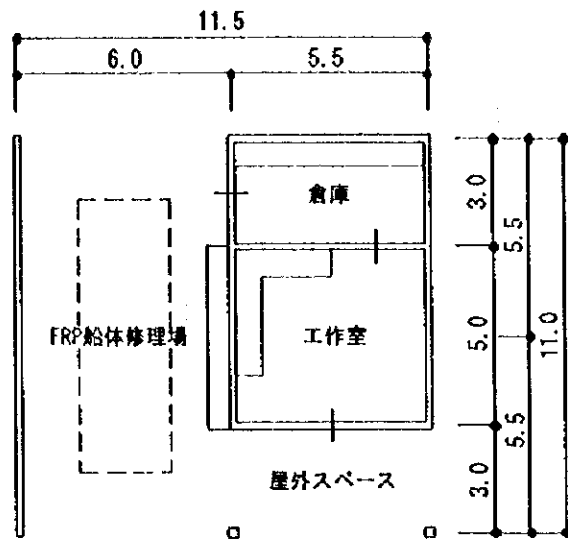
レラ FRP 船体ワークショップ棟平面図
